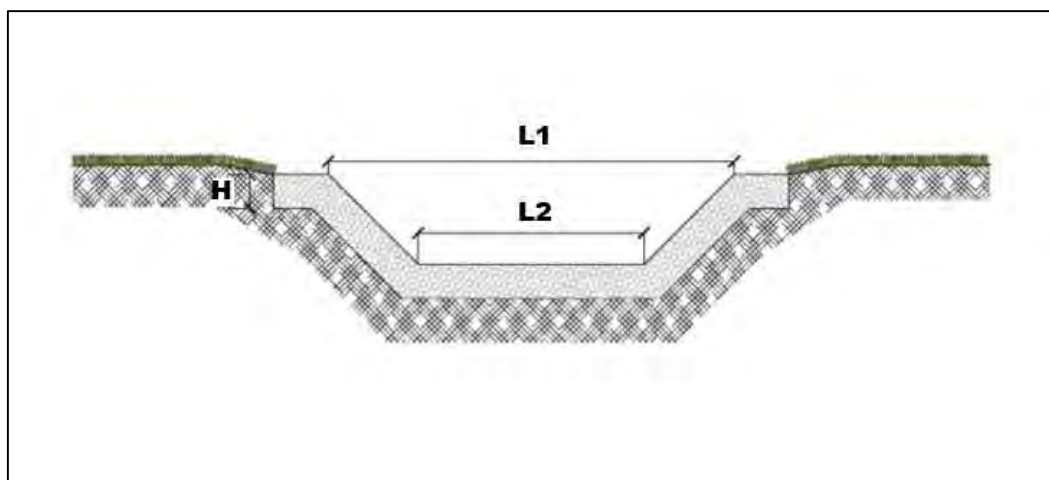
Sezione tipo del canale trapezoidale rivestito in materassi Reno
